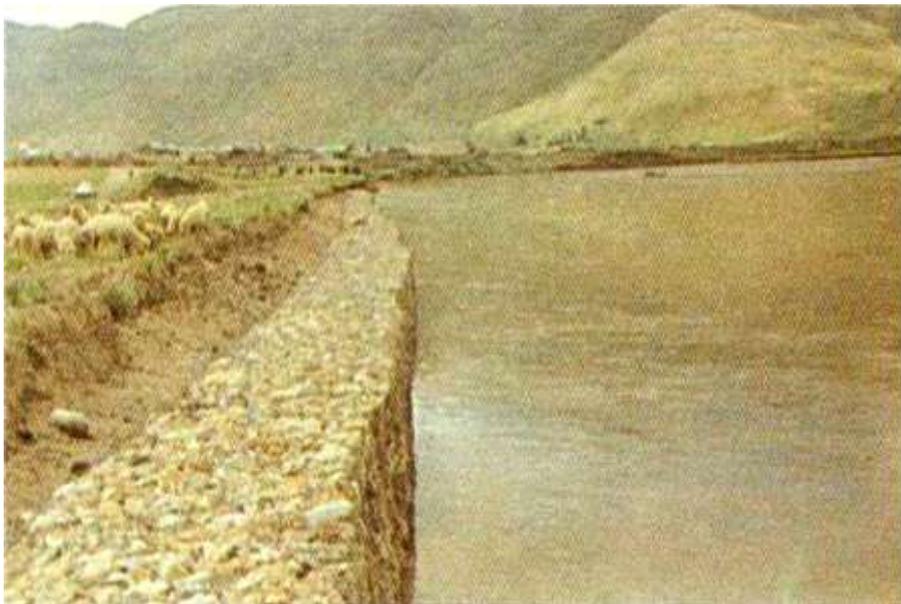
Ejemplo de muro longitudinal para el encauzamiento del río. (Tomado de PROLANSA).
